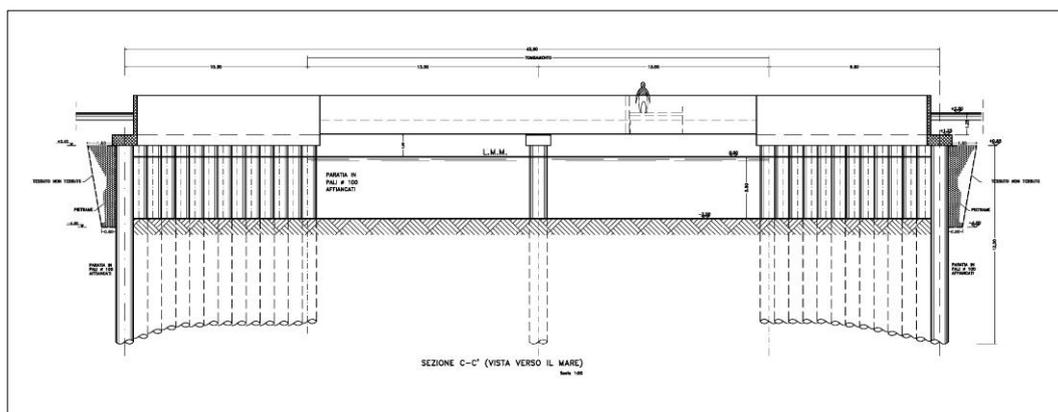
Tratto tombato Fosso della Fiumaretta: sezione trasversale tratto imbocco.
